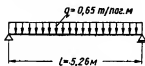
Расчетная схема панели и схема нагрузки.
